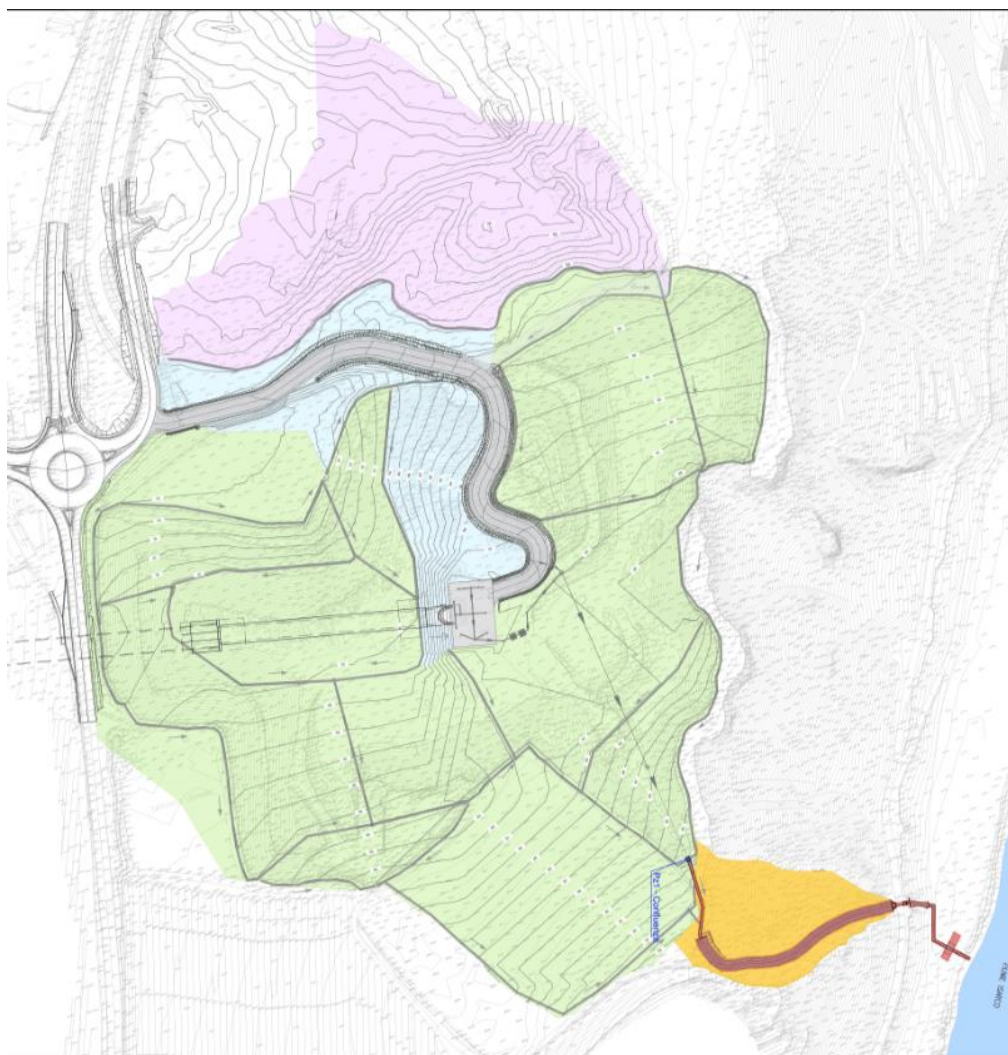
Planimetria idraulica Deposito Forch con recapito nell'Isarco (PD)
